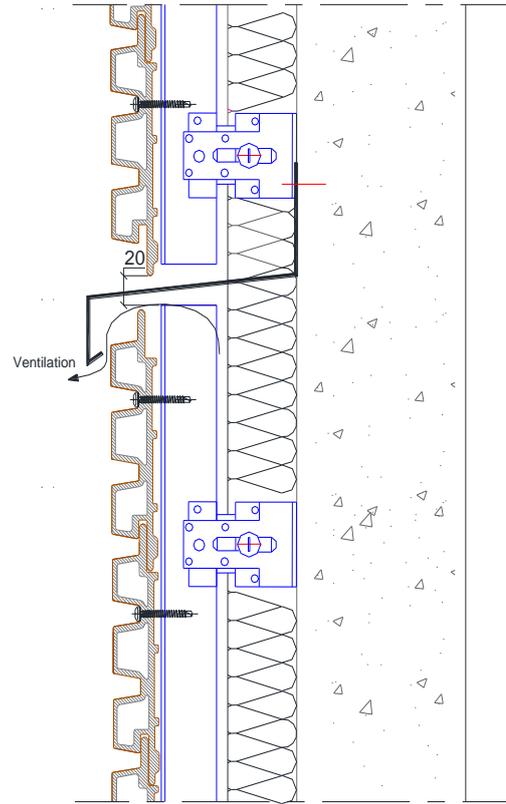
Fractionnement de l’ossature en pose horizontale : Longueur du montant acier > 6 m ou du montant aluminium > 3 m
